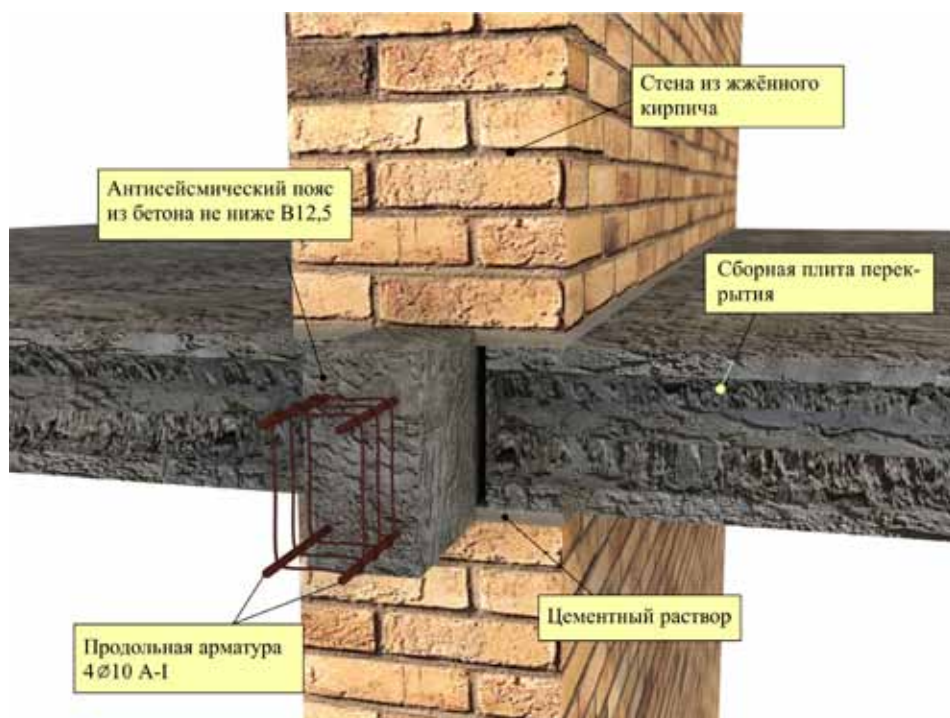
Железобетонный антисейсмический пояс на внутренней стене
